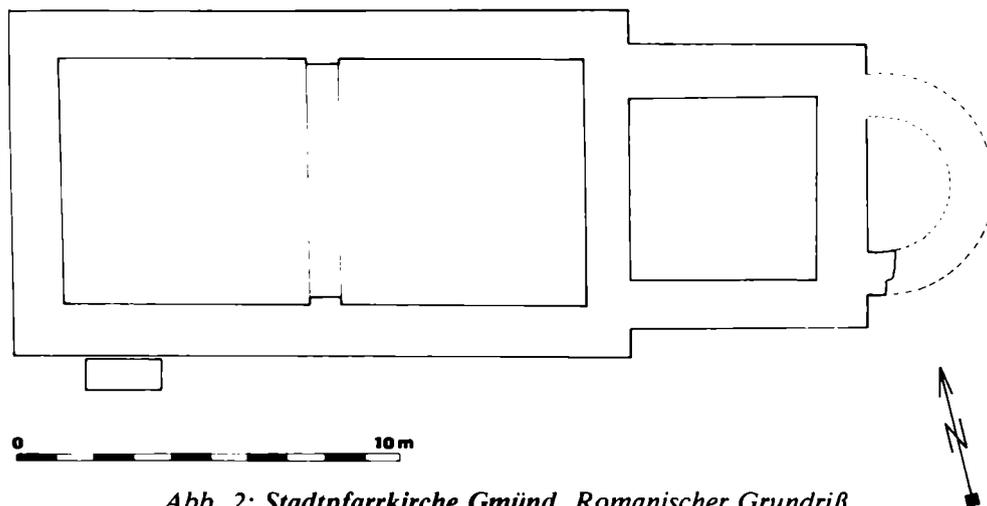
Stadtpfarrkirche Gmünd, Romanischer Grundriß
